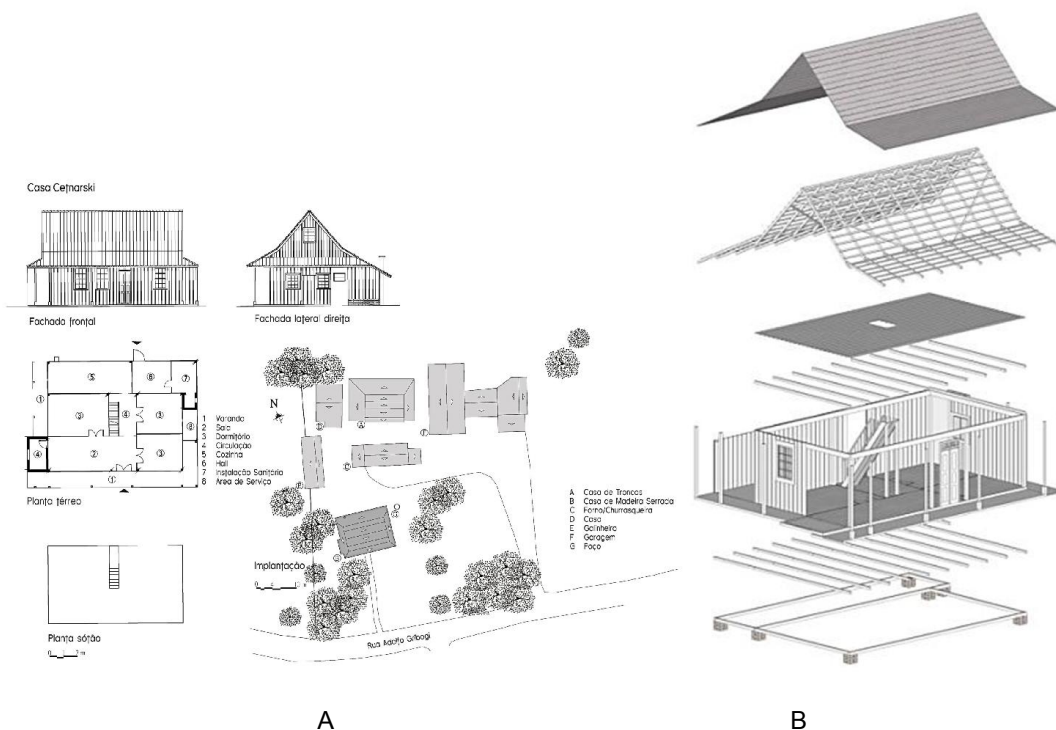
PLANTA E FACHADAS (A), PERSPECTIVA DA CASA CETNARSKI (B)
